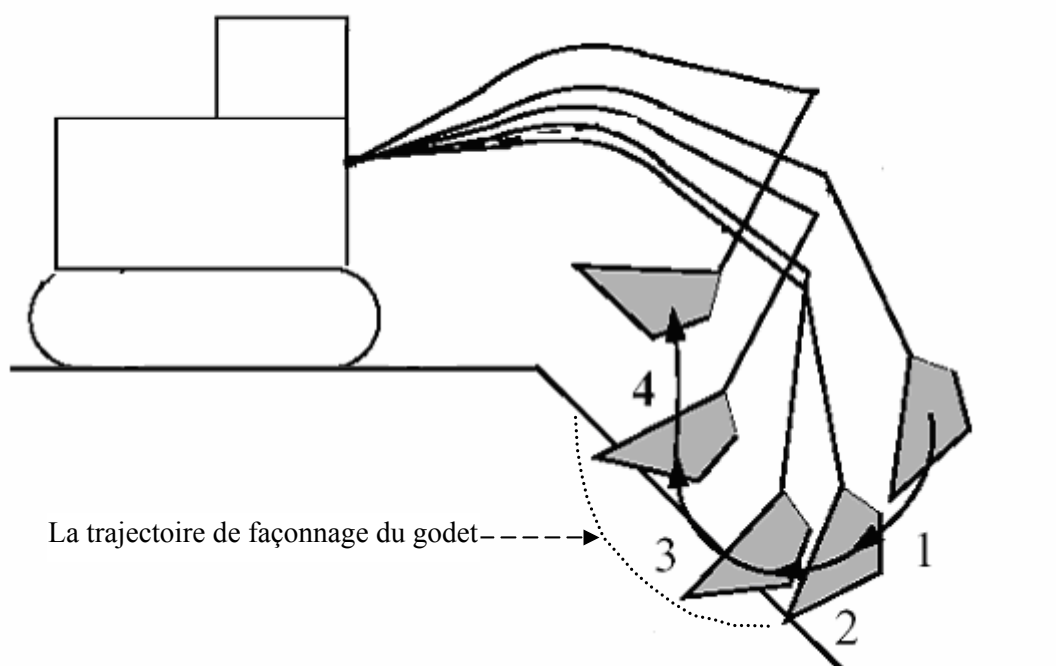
Procédure d'excavation automatique d'une fondation.
